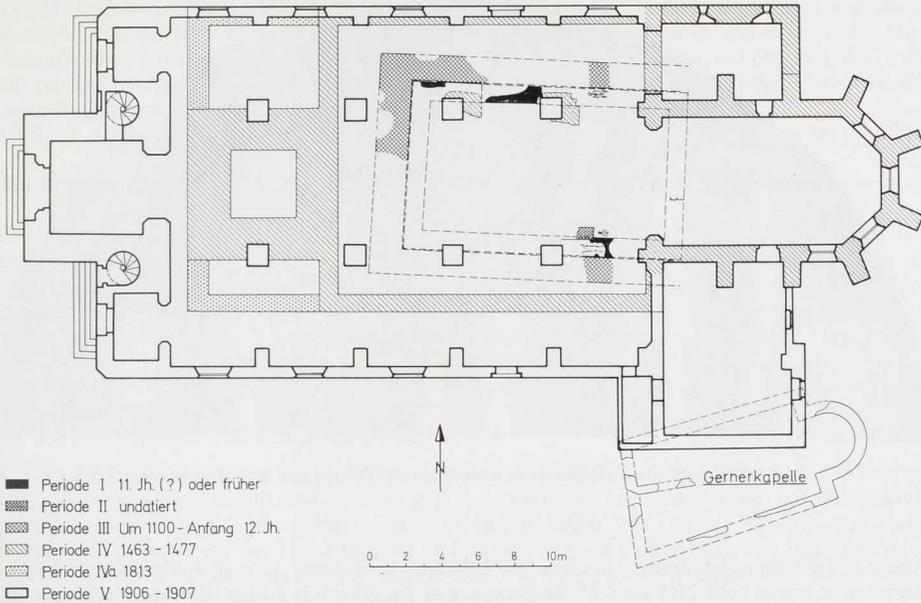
Baden-Baden—Steinbach. Jakobuskirche; Grundriß mit Befunden.
